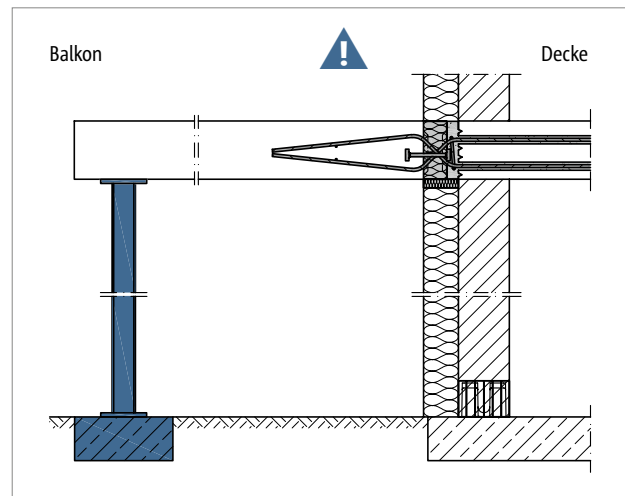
Schöck Isokorb® RT Typ Q-P-VV: Stützung durchgängig erforderlich
